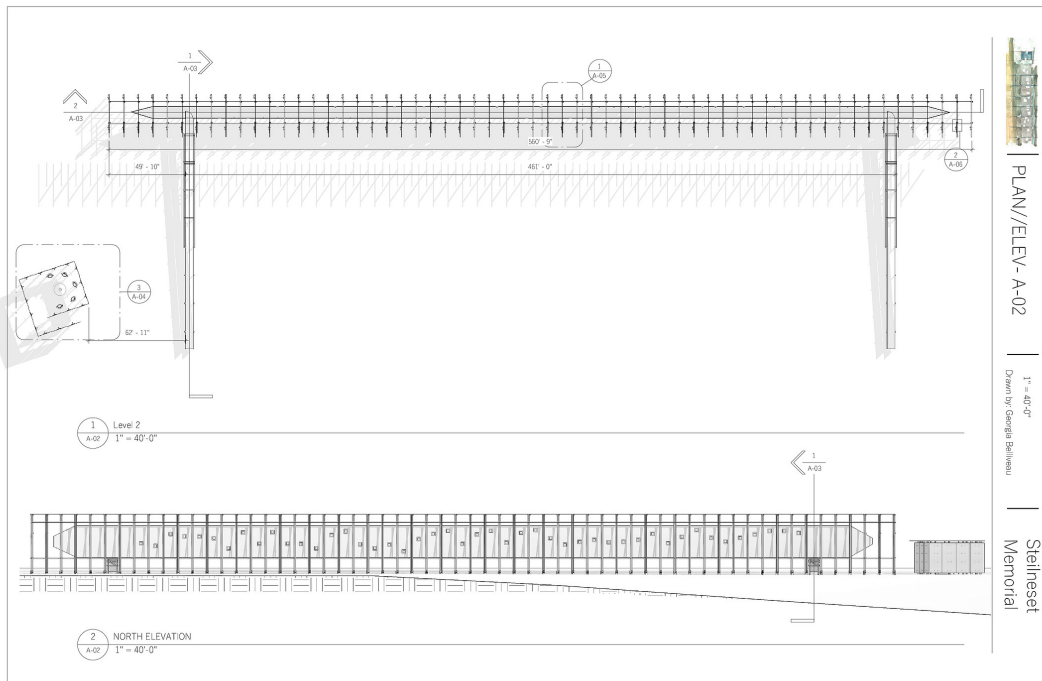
y 9. Planta elevación y secciones arquitectónicas de Memorial
